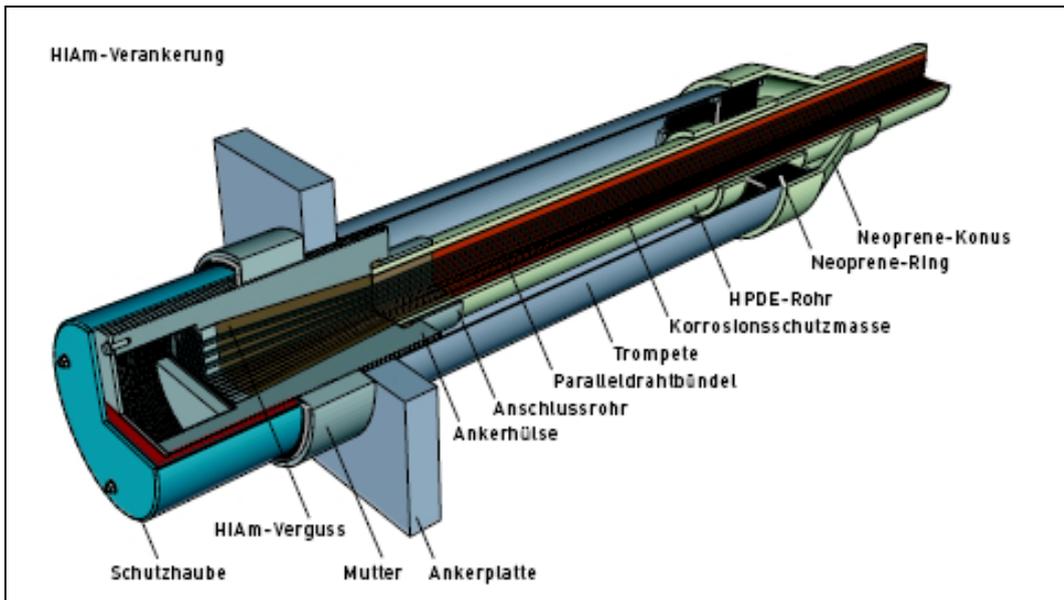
Paralleldrahtseil mit Verankerung Typ HiAm [8].
